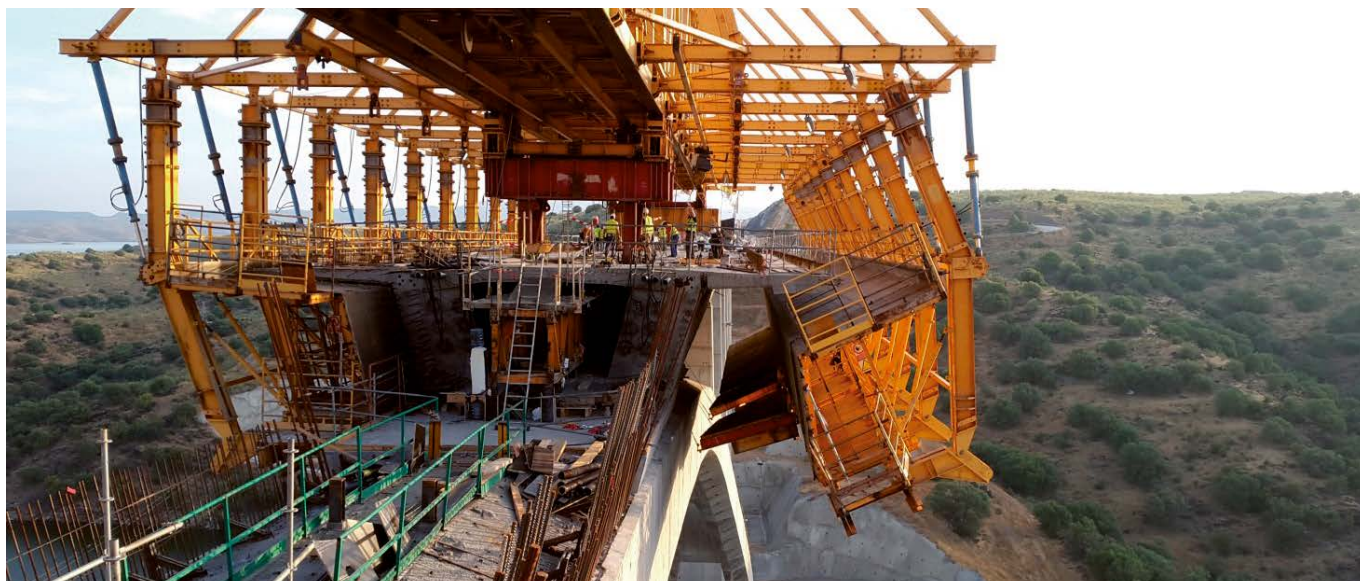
Apertura de la autocimbra despues de desconectar los paneles de fondo (Solución AP-Bridge).
